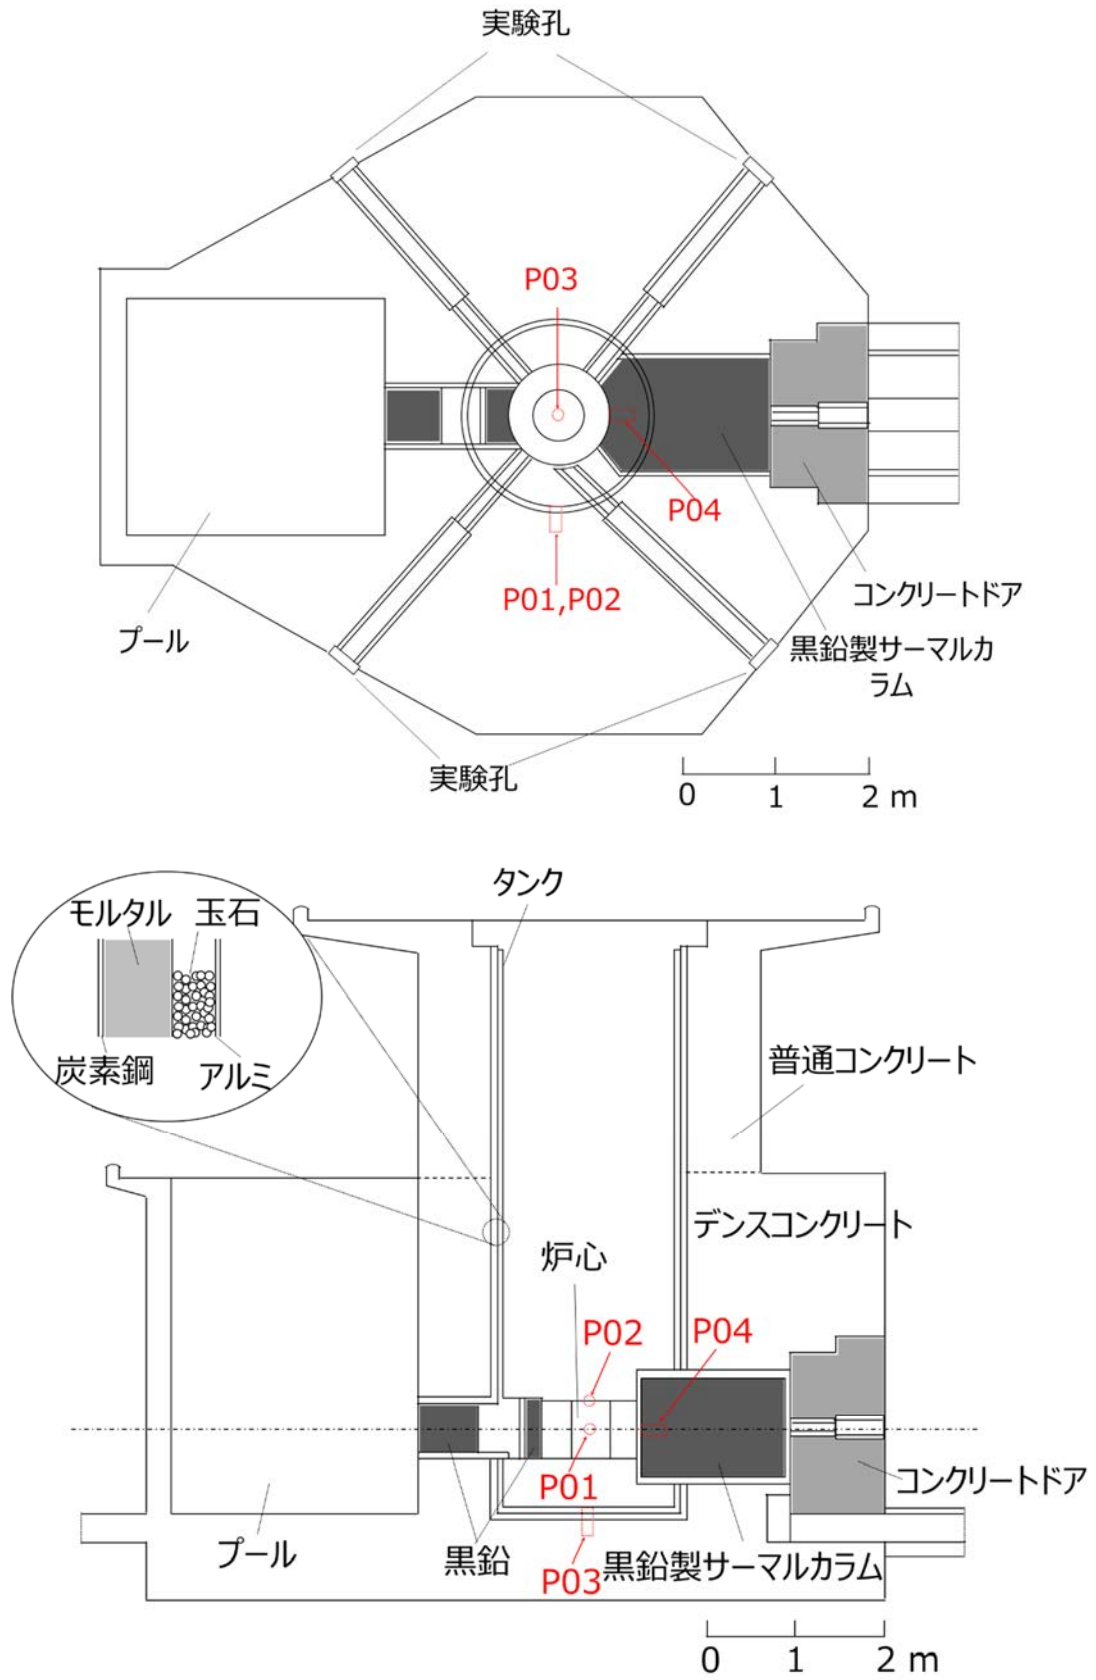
立教炉の概略図（上：平面図、下：立面図）
